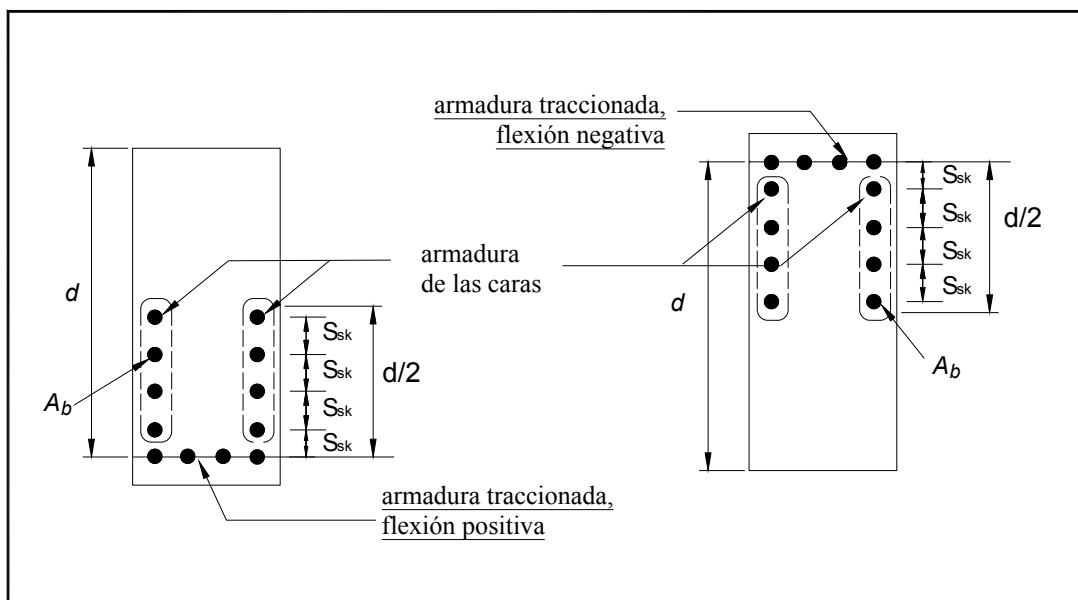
Armadura para las caras de vigas y viguetas con $d > 36$ in
